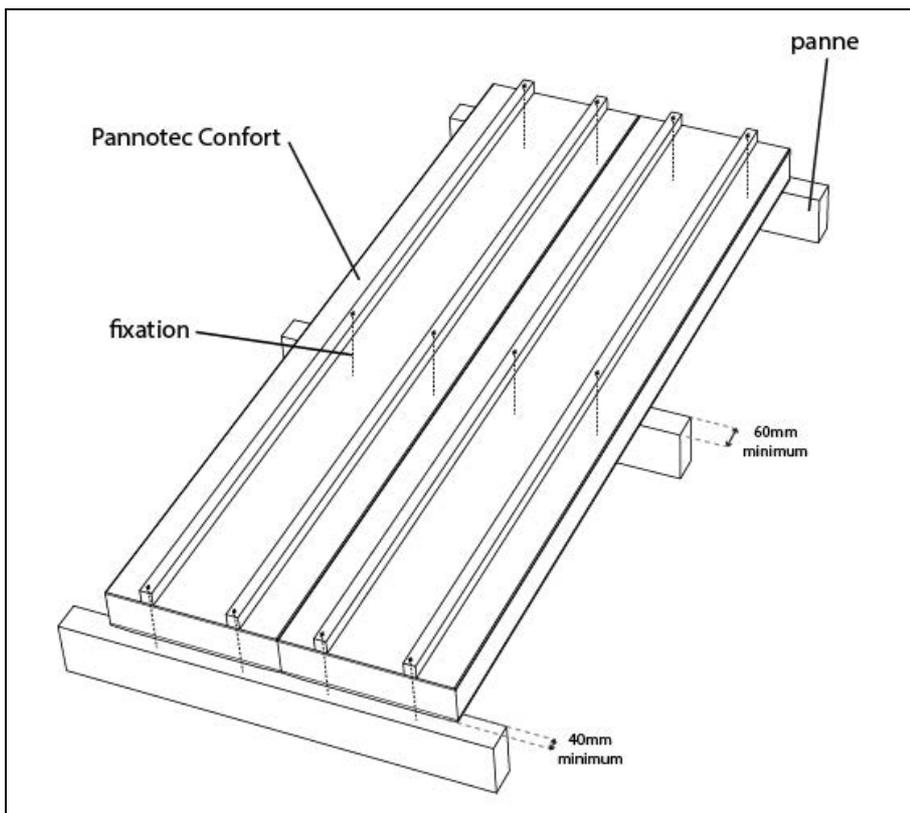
Pose normale sur pannes (parallèle au rampant)
